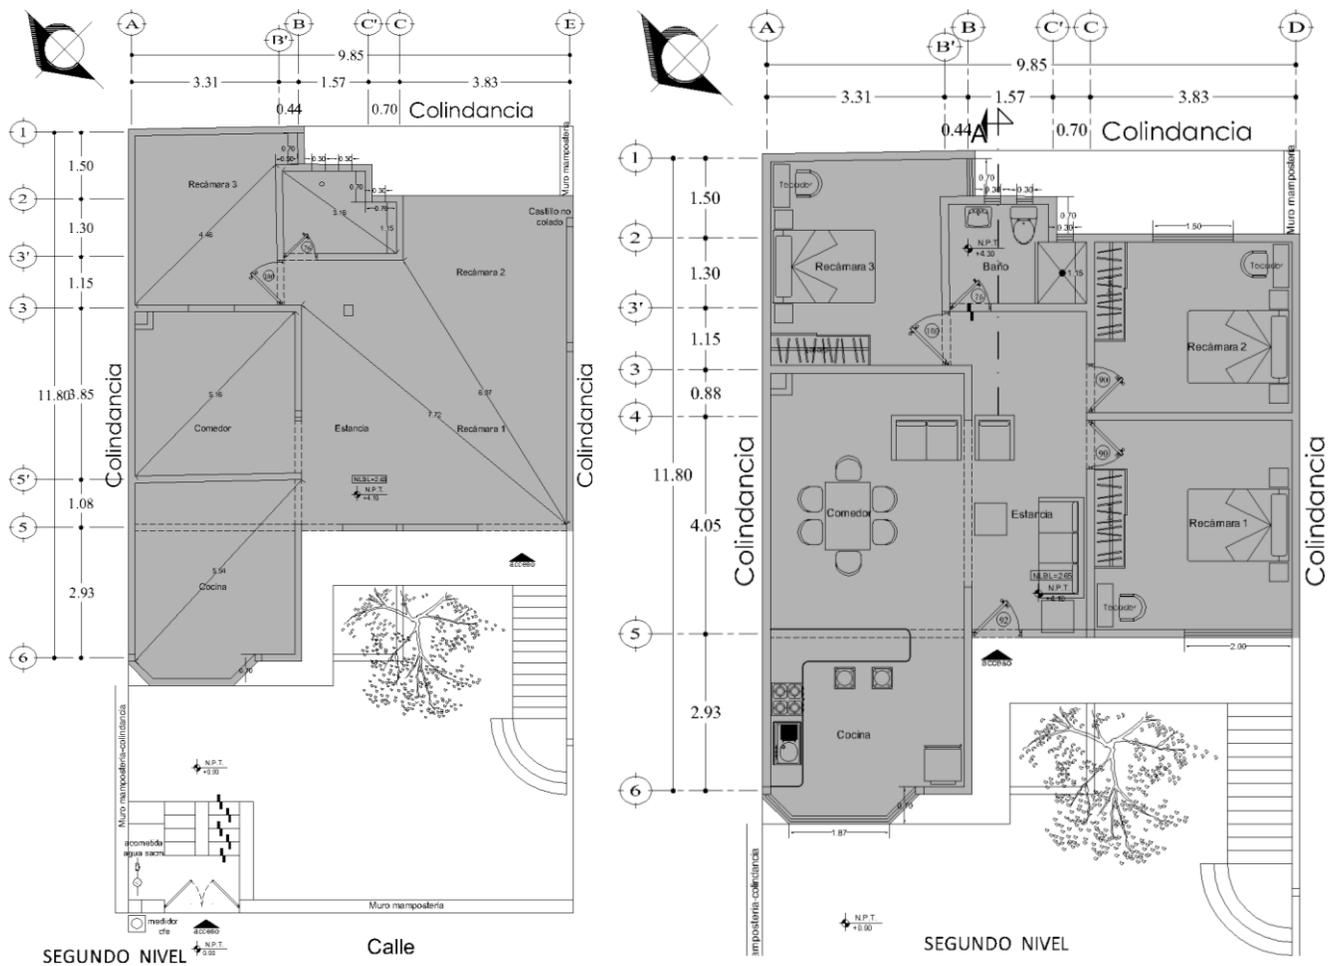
Planos de lo existente y la propuesta de diseño. Foto: Elaboración propia. 10 de abril 2024.
